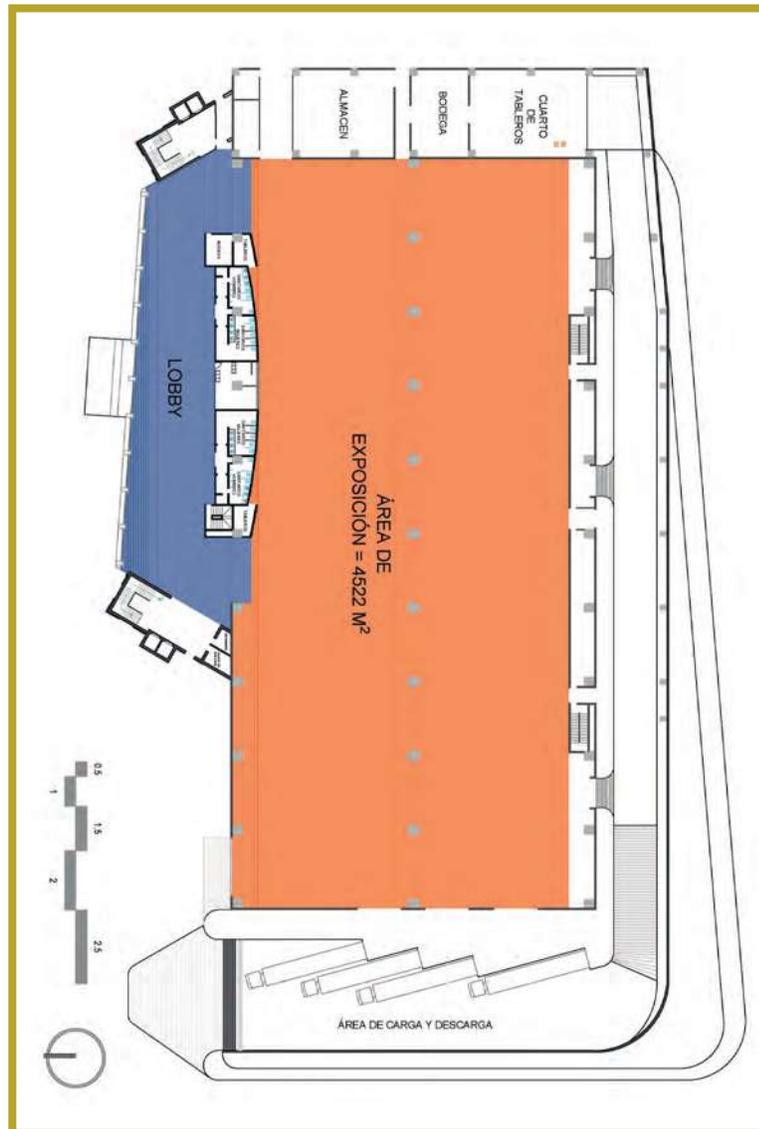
Layout del Centro de Exposiciones.¹² (Ver apartado de planimetría)
